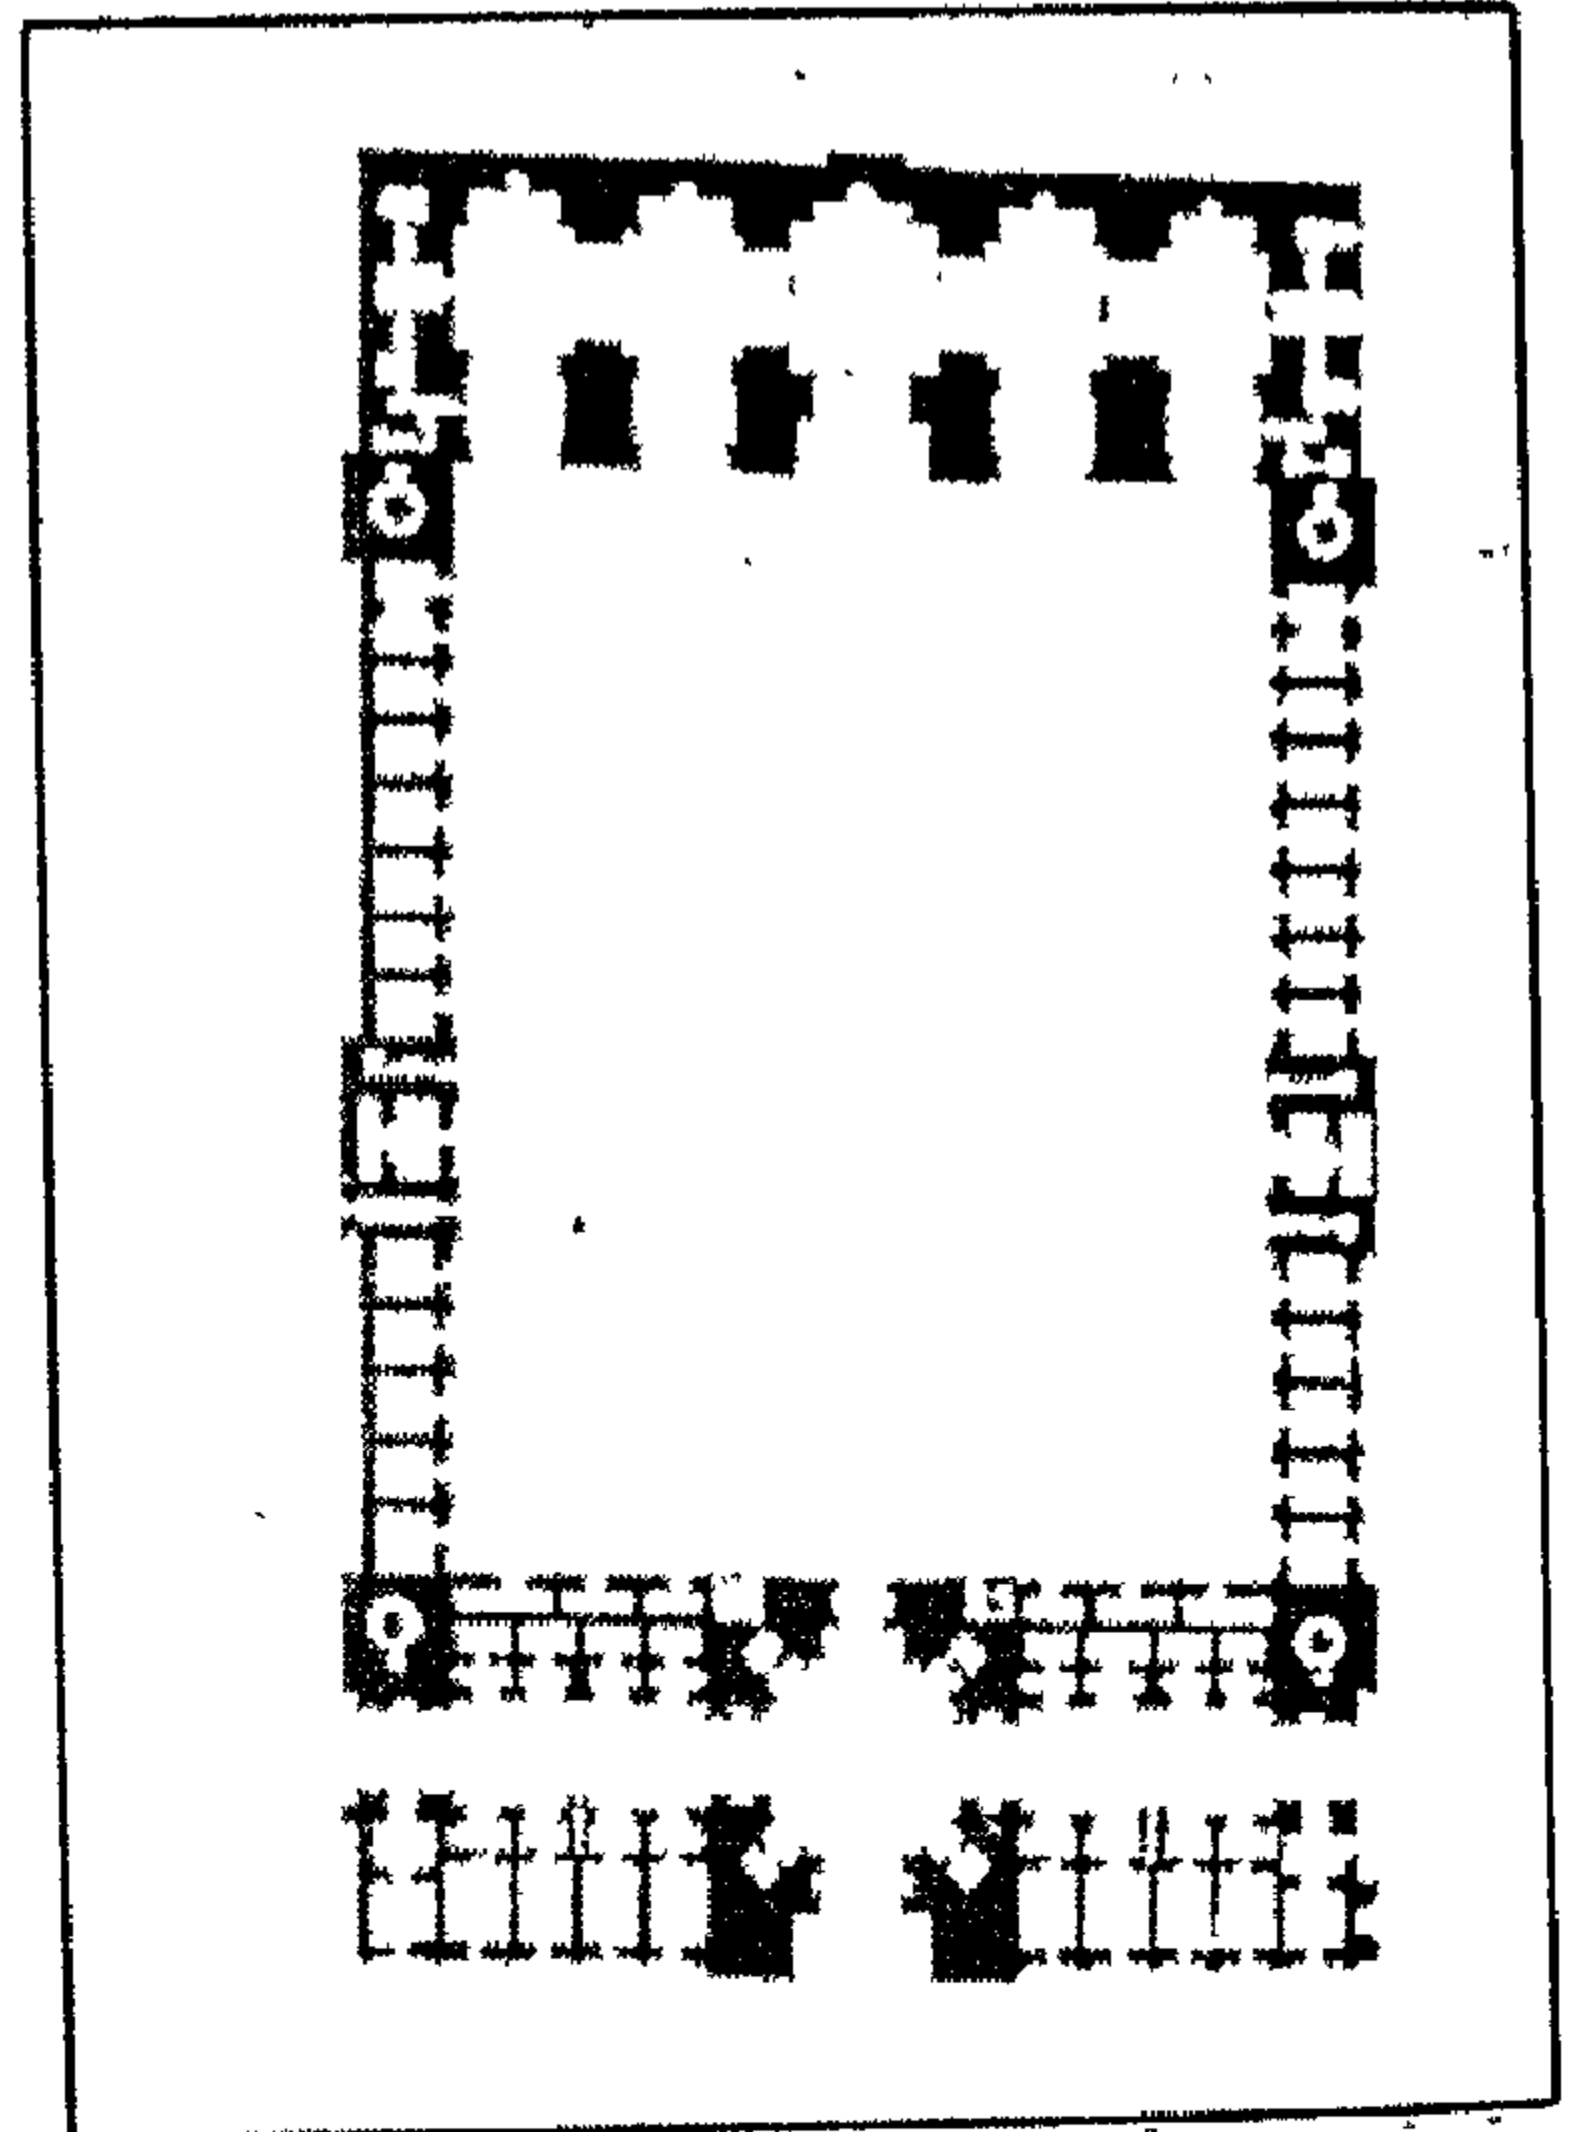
مسجد العاقولي ببغداد (مسقط أفقي)
